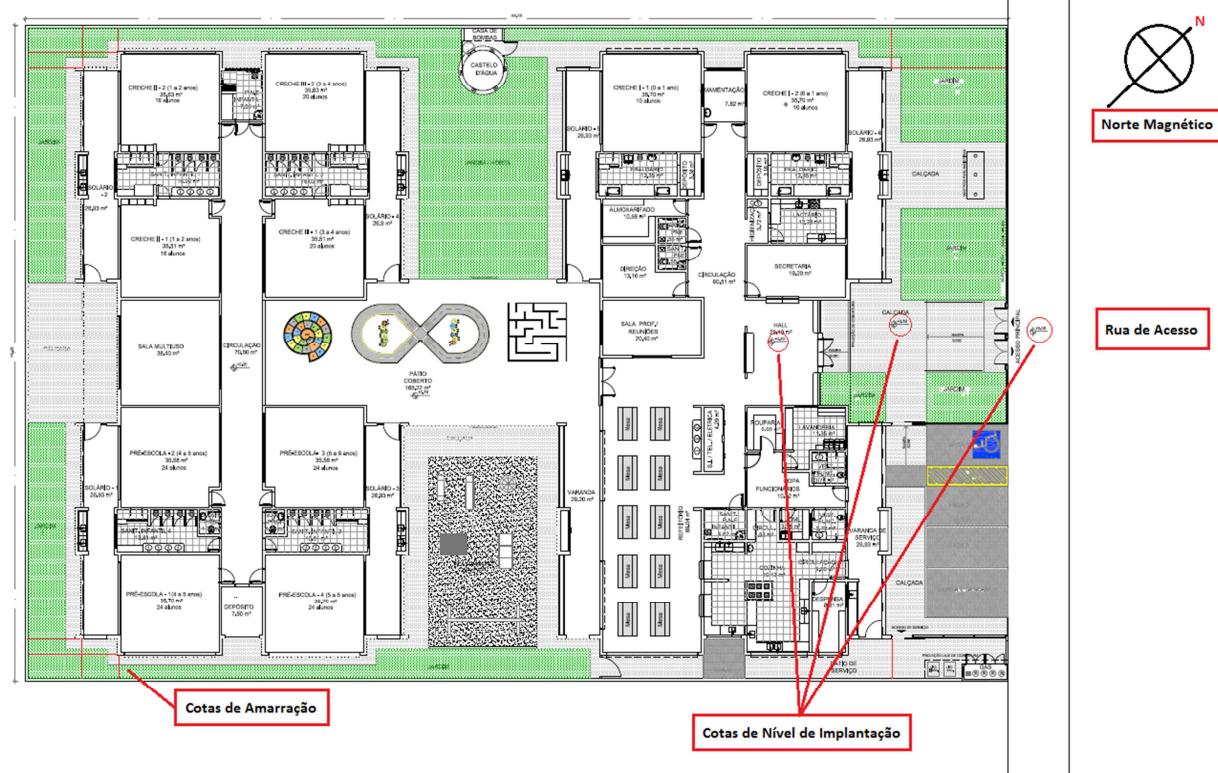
Exemplo de “Planta de Locação” da obra da Creche Tipo 1.
